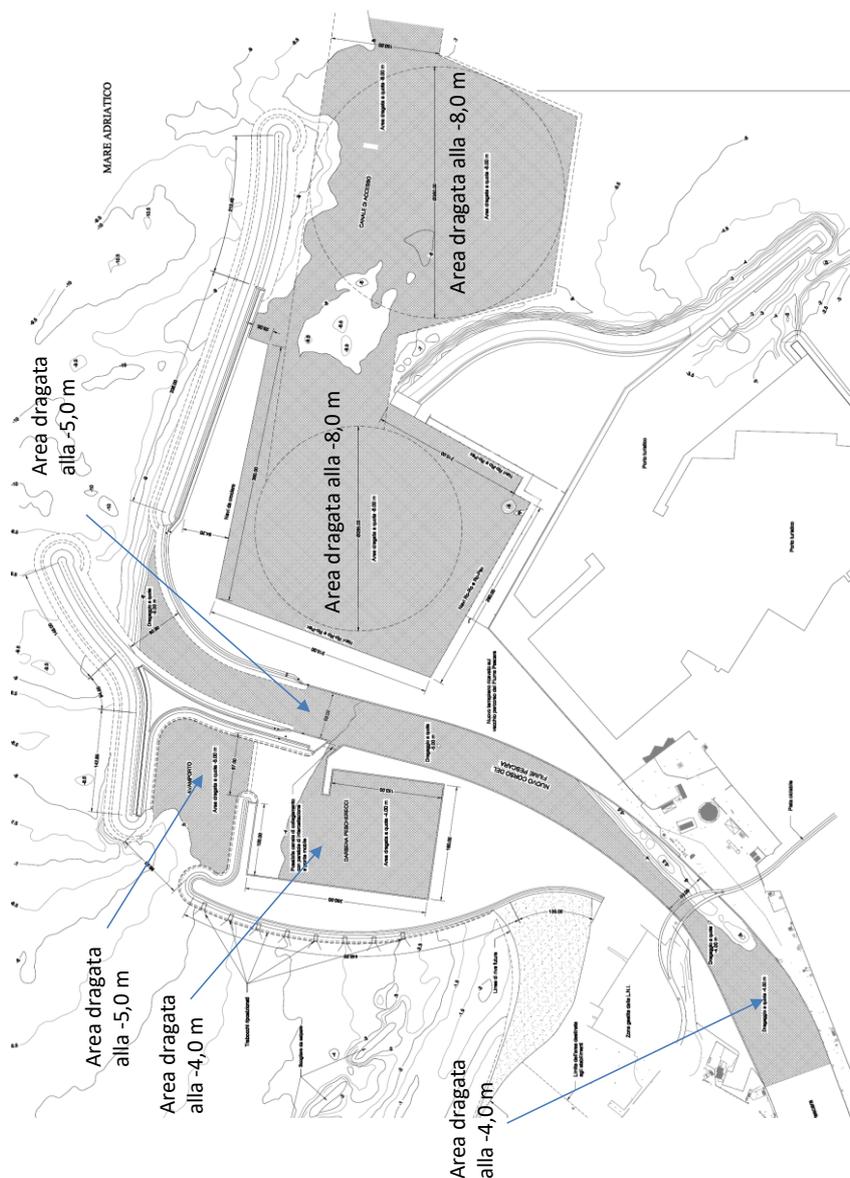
Porto di Pescara: PRP 2008 – Planimetria dei dragaggi.
